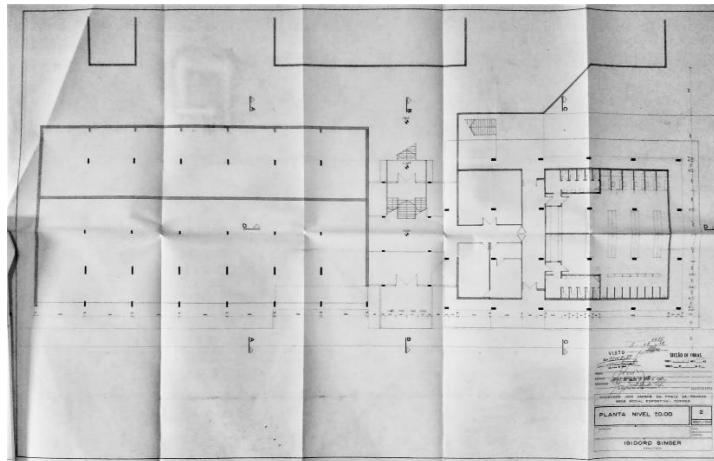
Planta baixa nível 0,00. Projeto executivo de 1979. Arquiteto Isidoro Singer
